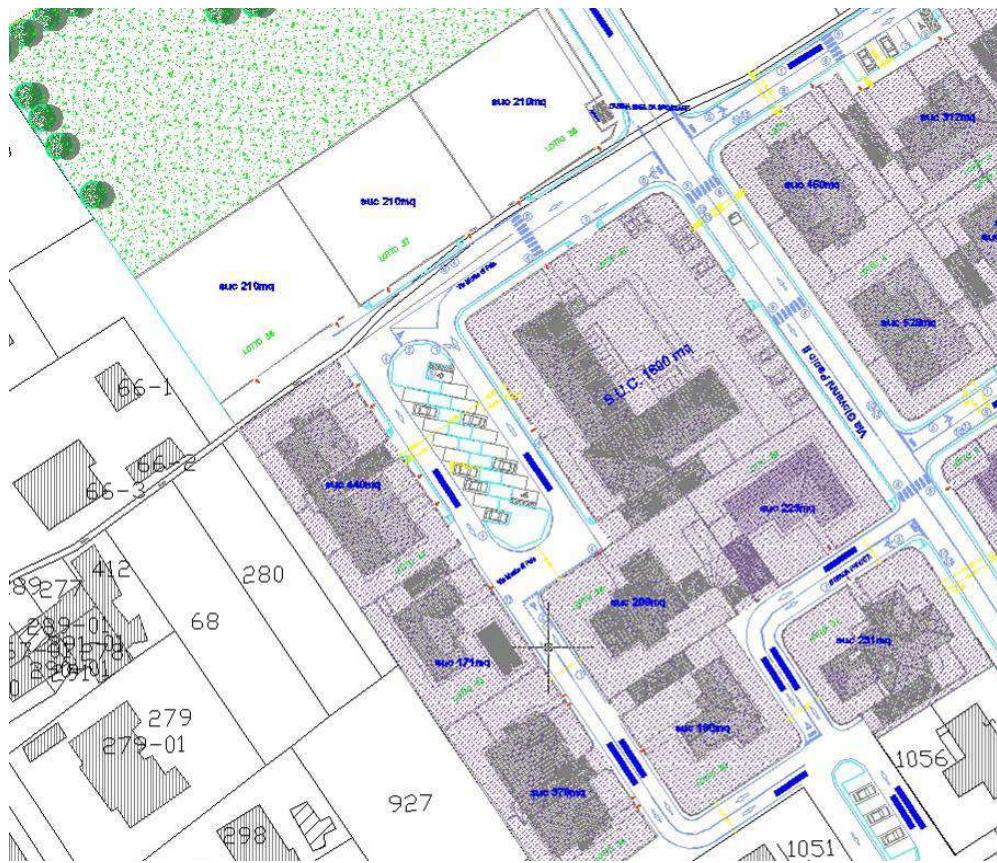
Planimetria generale dello Stato Attuale – Zoom A –
